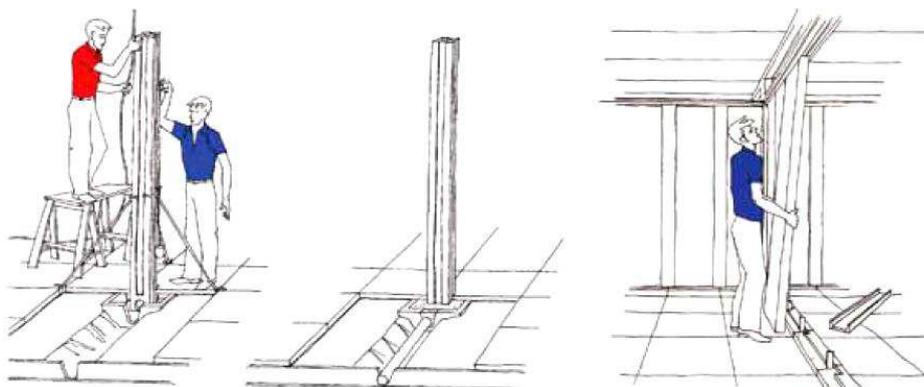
Escolas em Abadiânia - Pré-fabricação de divisórias e esquema de montagem facilitado.
